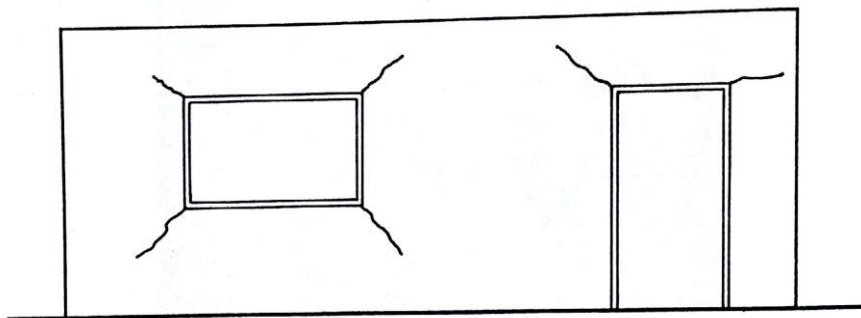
Fissuração típica da alvenaria causada por sobrecarga vertical.
